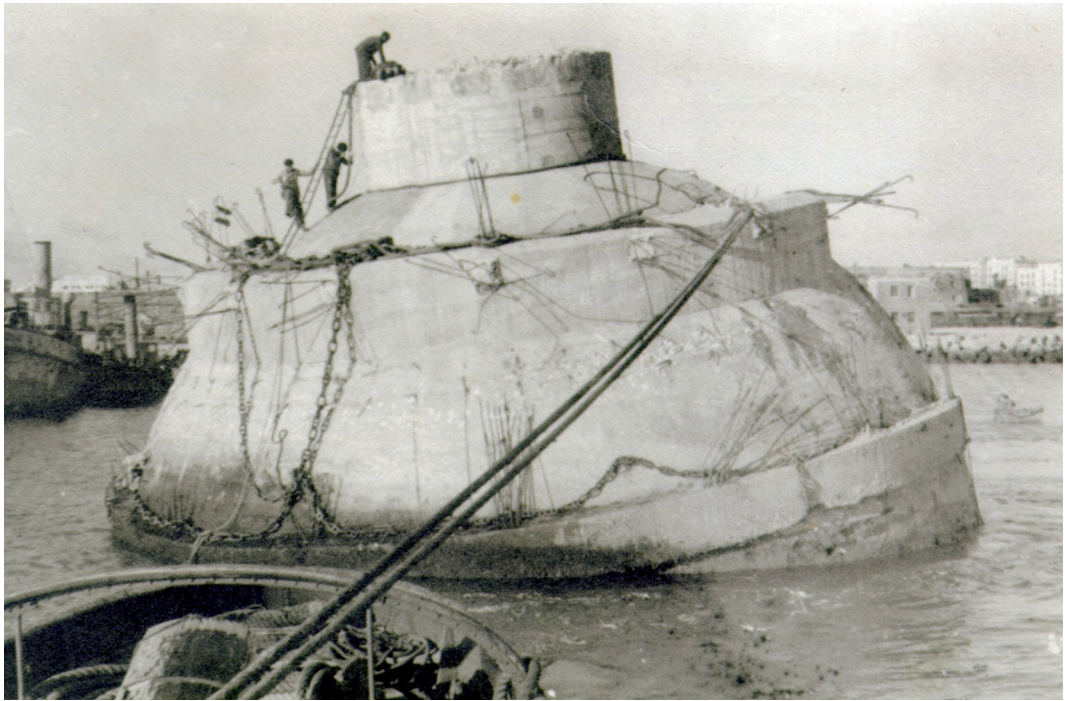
y 17. Fabricación de cajones de hormigón armado en dique seco de Cádiz.
